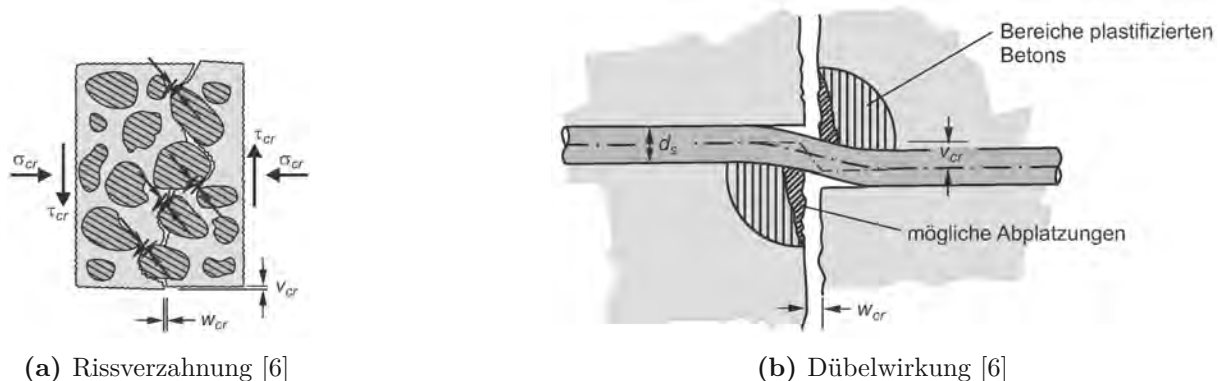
Kraftübertragungsmechanismen am Rissufer von gerissenem Beton mit Bewehrung
